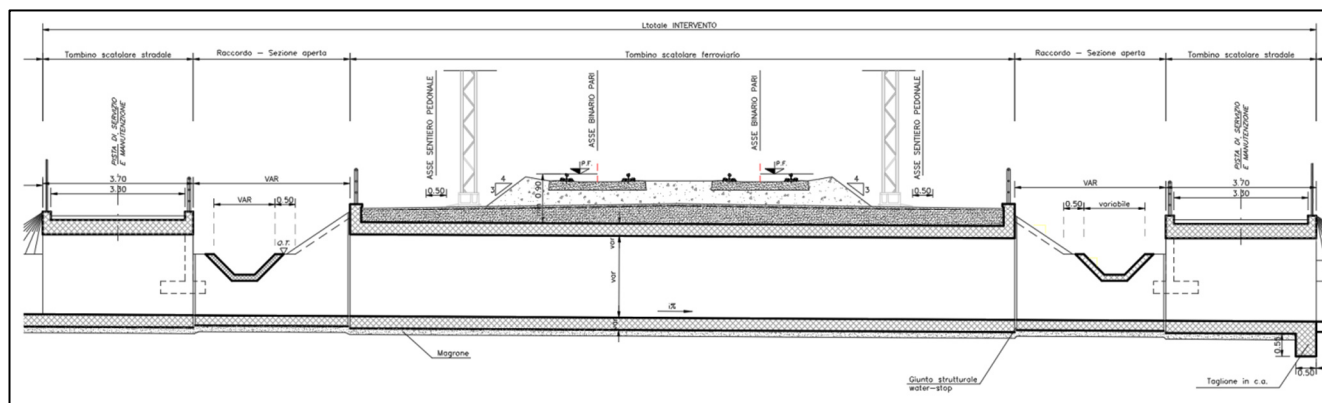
Attraversamenti idraulici – sezione longitudinale tipo
